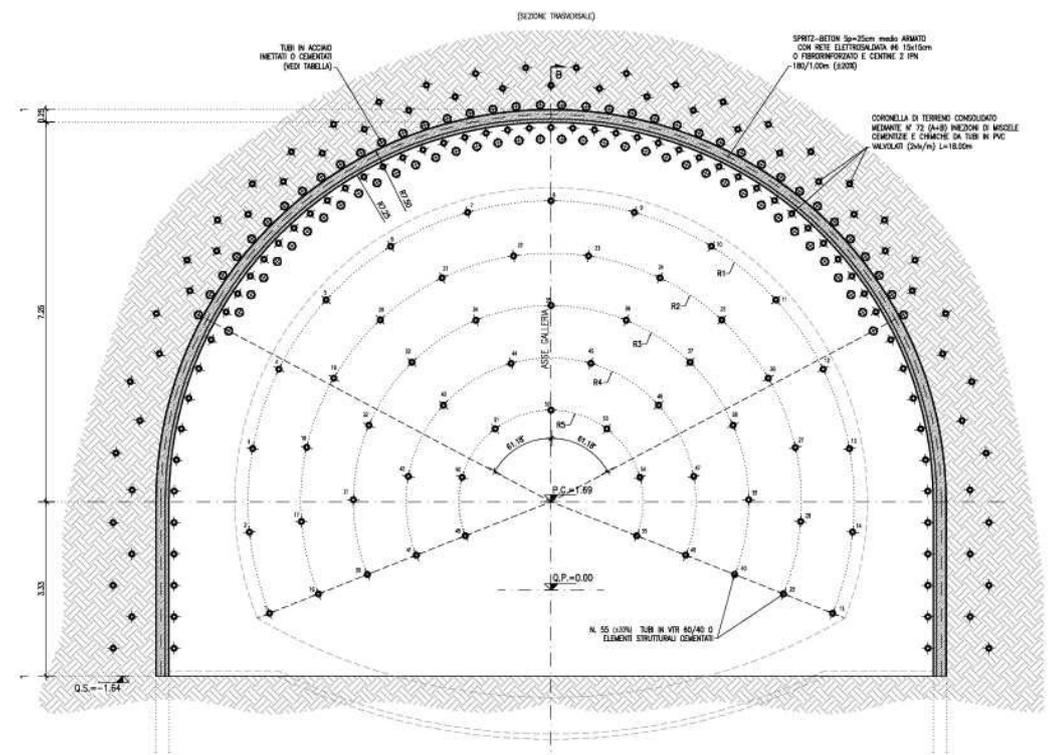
Sezione di scavo tipo C1V – Sezione trasversale
